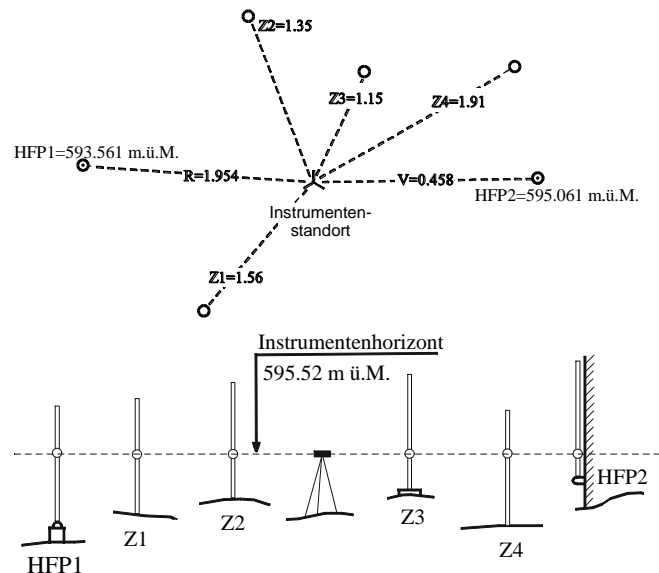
Flächennivellement (oben: Darstellung im Grundriss, unten: Darstellung im Aufriss)
